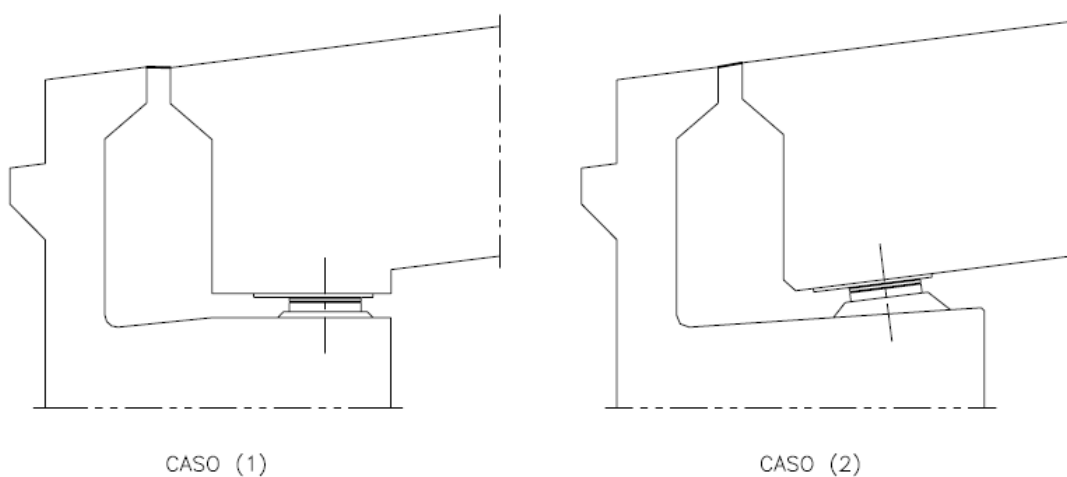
Inclinação no Plano Horizontal (Caso 1) Inclinação no Plano Inclinado (Caso 2) (Jacinto, 2004)
